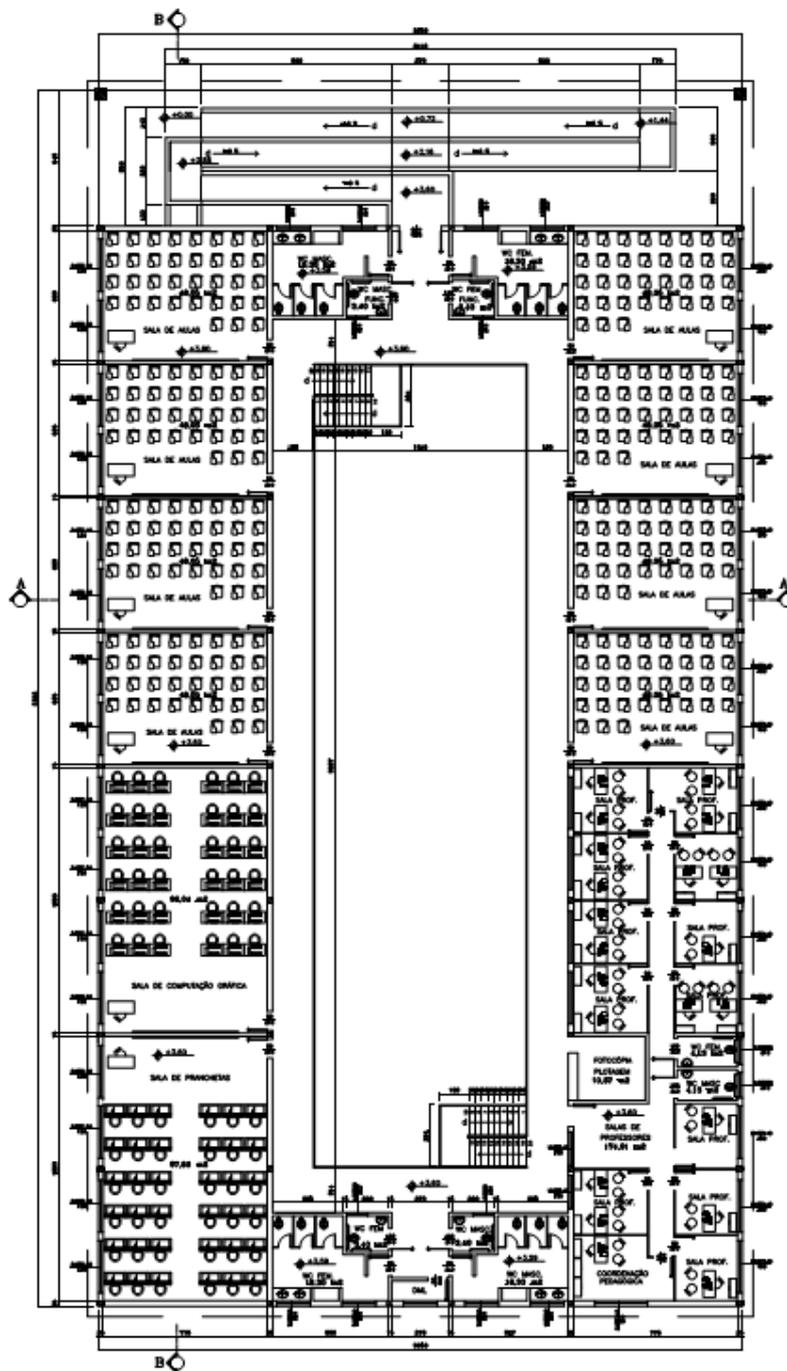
Planta Baixa do Pavimento Superior do Bloco de Edificações.
